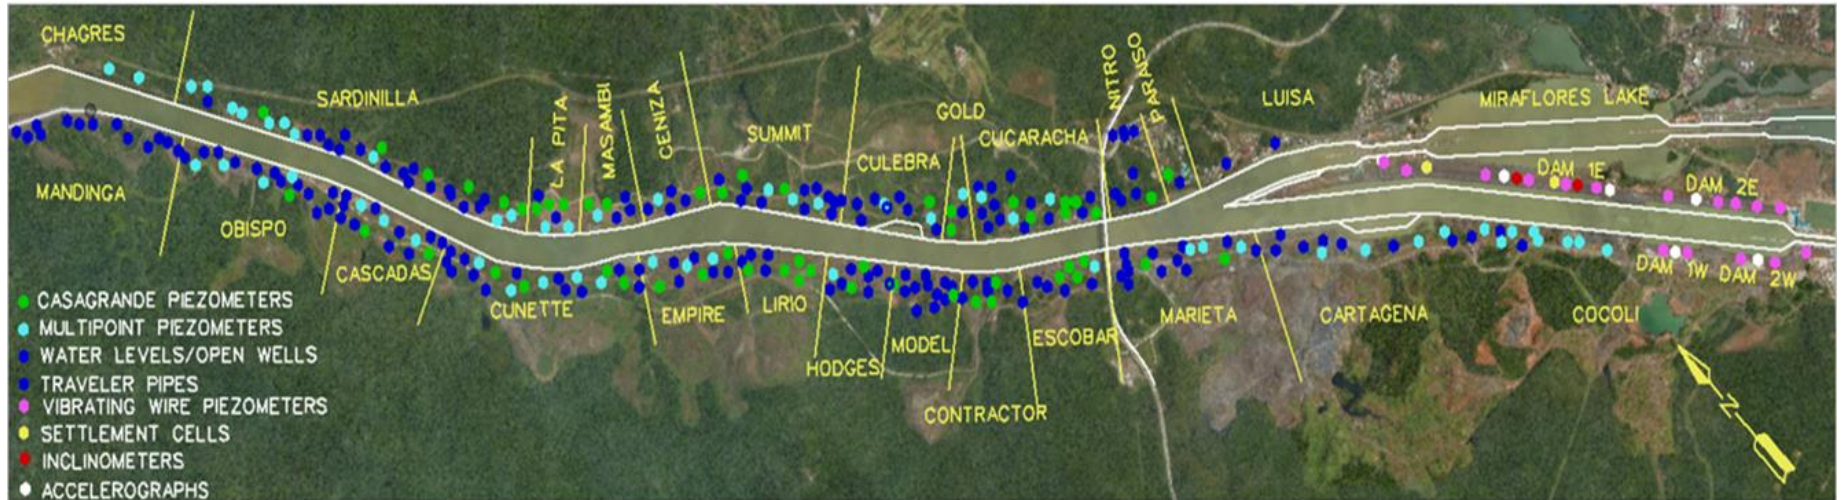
Planta de ubicación de la instrumentación subterránea
